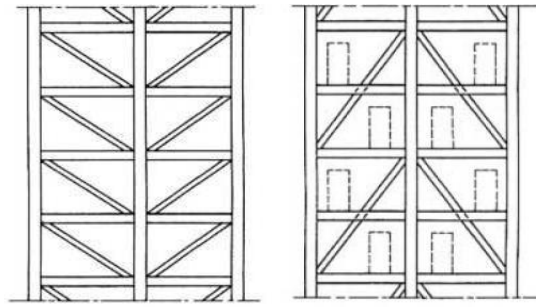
a)- sur la hauteur d'un étage b)- sur la hauteur de deux étages
